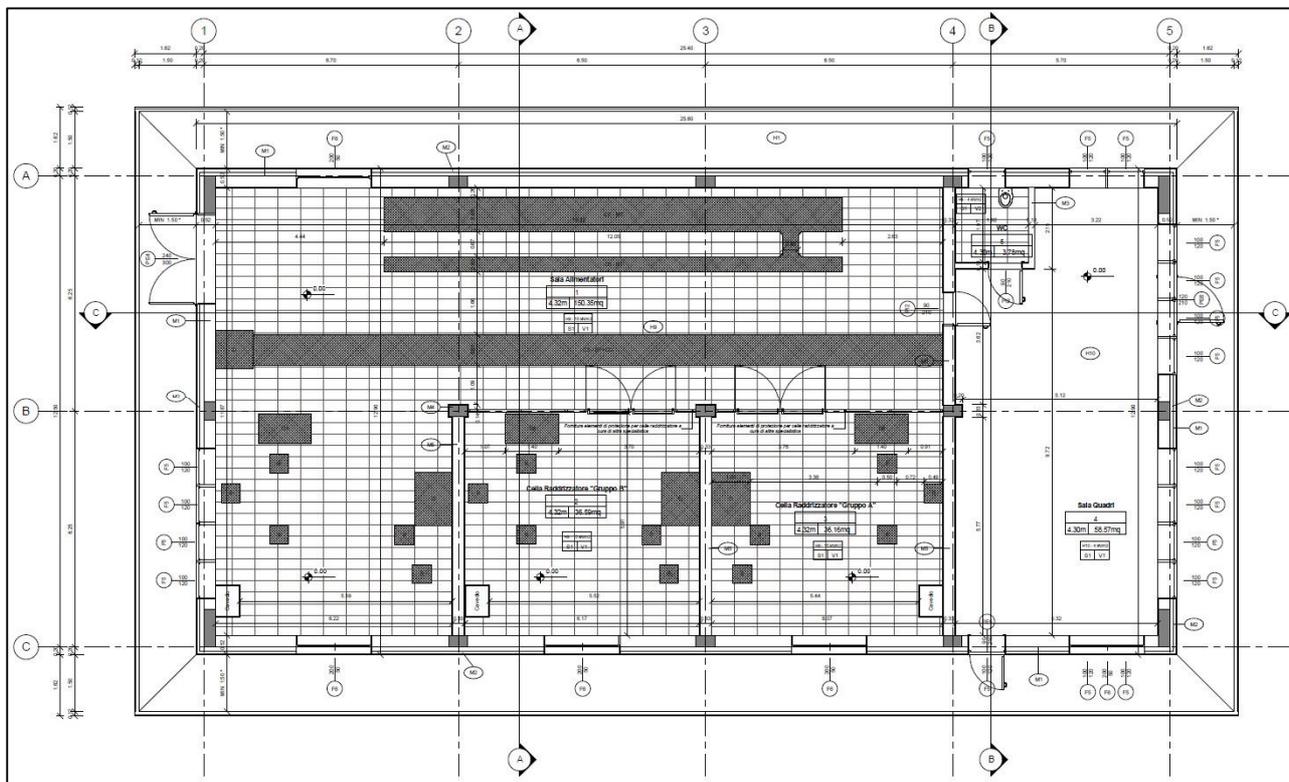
SSE Borgone – Pianta architettonica piano terra
